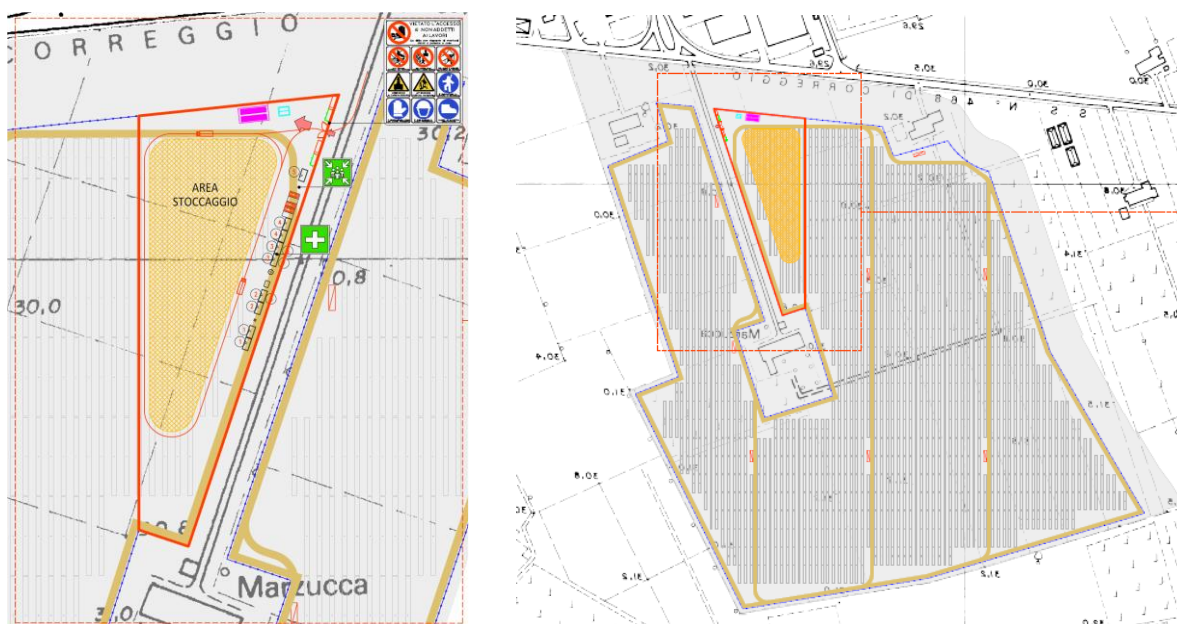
Stralcio delle aree di stoccaggio di cantiere.
